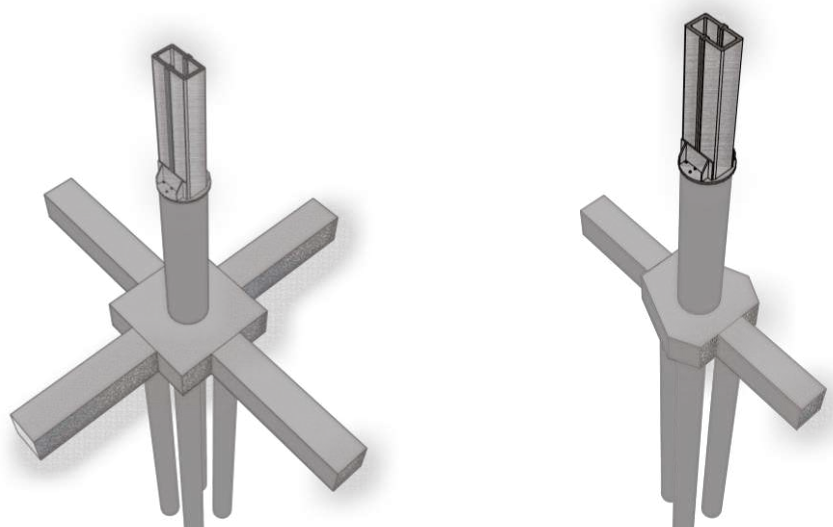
Encepado de base cuadrada, izquierda. Encepado de base triangular, derecha. Autor.
